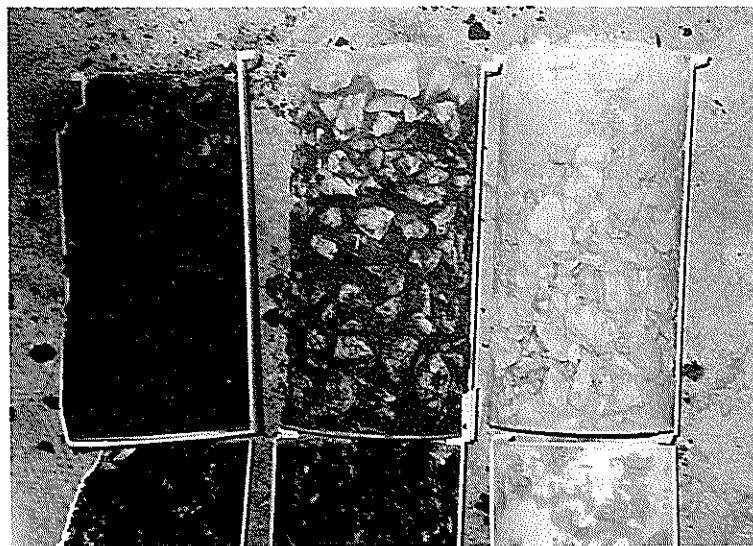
供試体内部（右からNo. 0-1, No. 1-1, No. 2-1）
